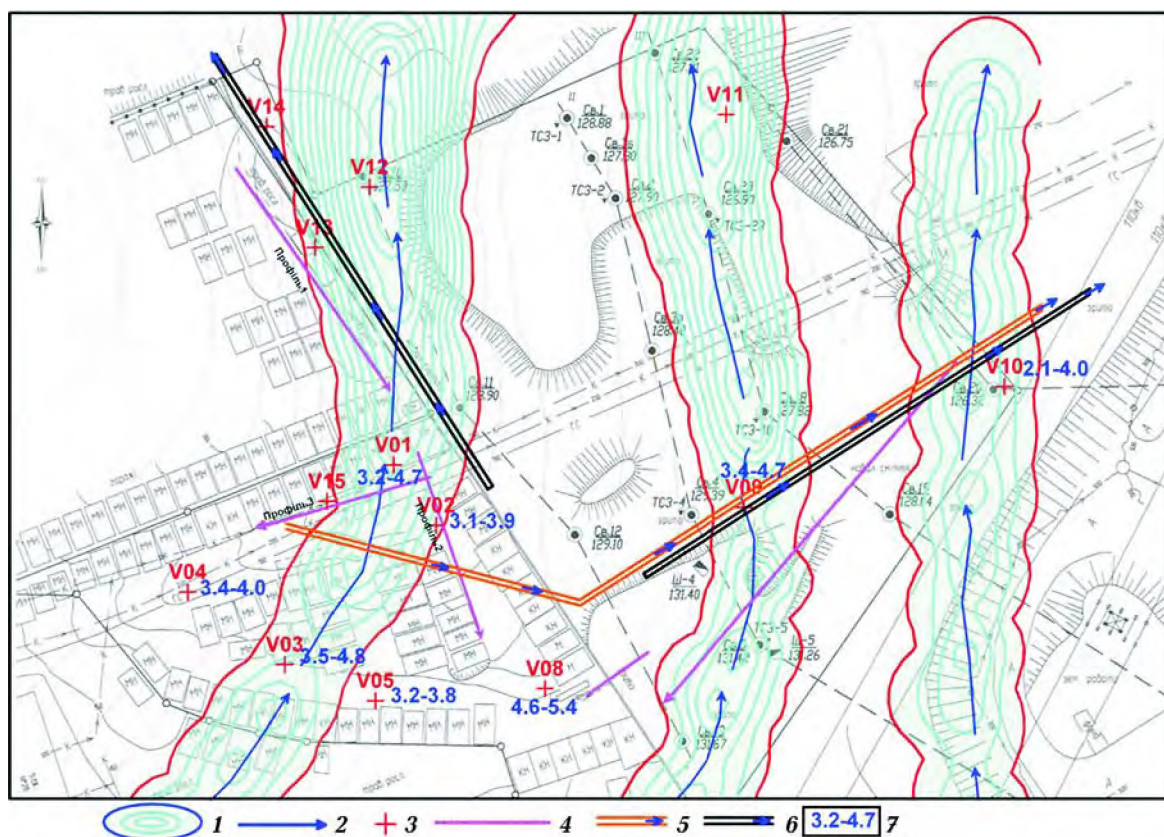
Возможные варианты строительства дренажа для отвода грунтовых вод со строительной площадки: 1 — зоны увлажнения грунтов; 2 — направления миграции грунтовых вод; 3 — пункты ВЭРЗ; 4 — профили георадарного зондирования; 5 — вариант дренажной системы № 1; 6 — вариант дренажной системы № 2; 7 — глубины кровли и подошвы первого водоносного горизонта.
